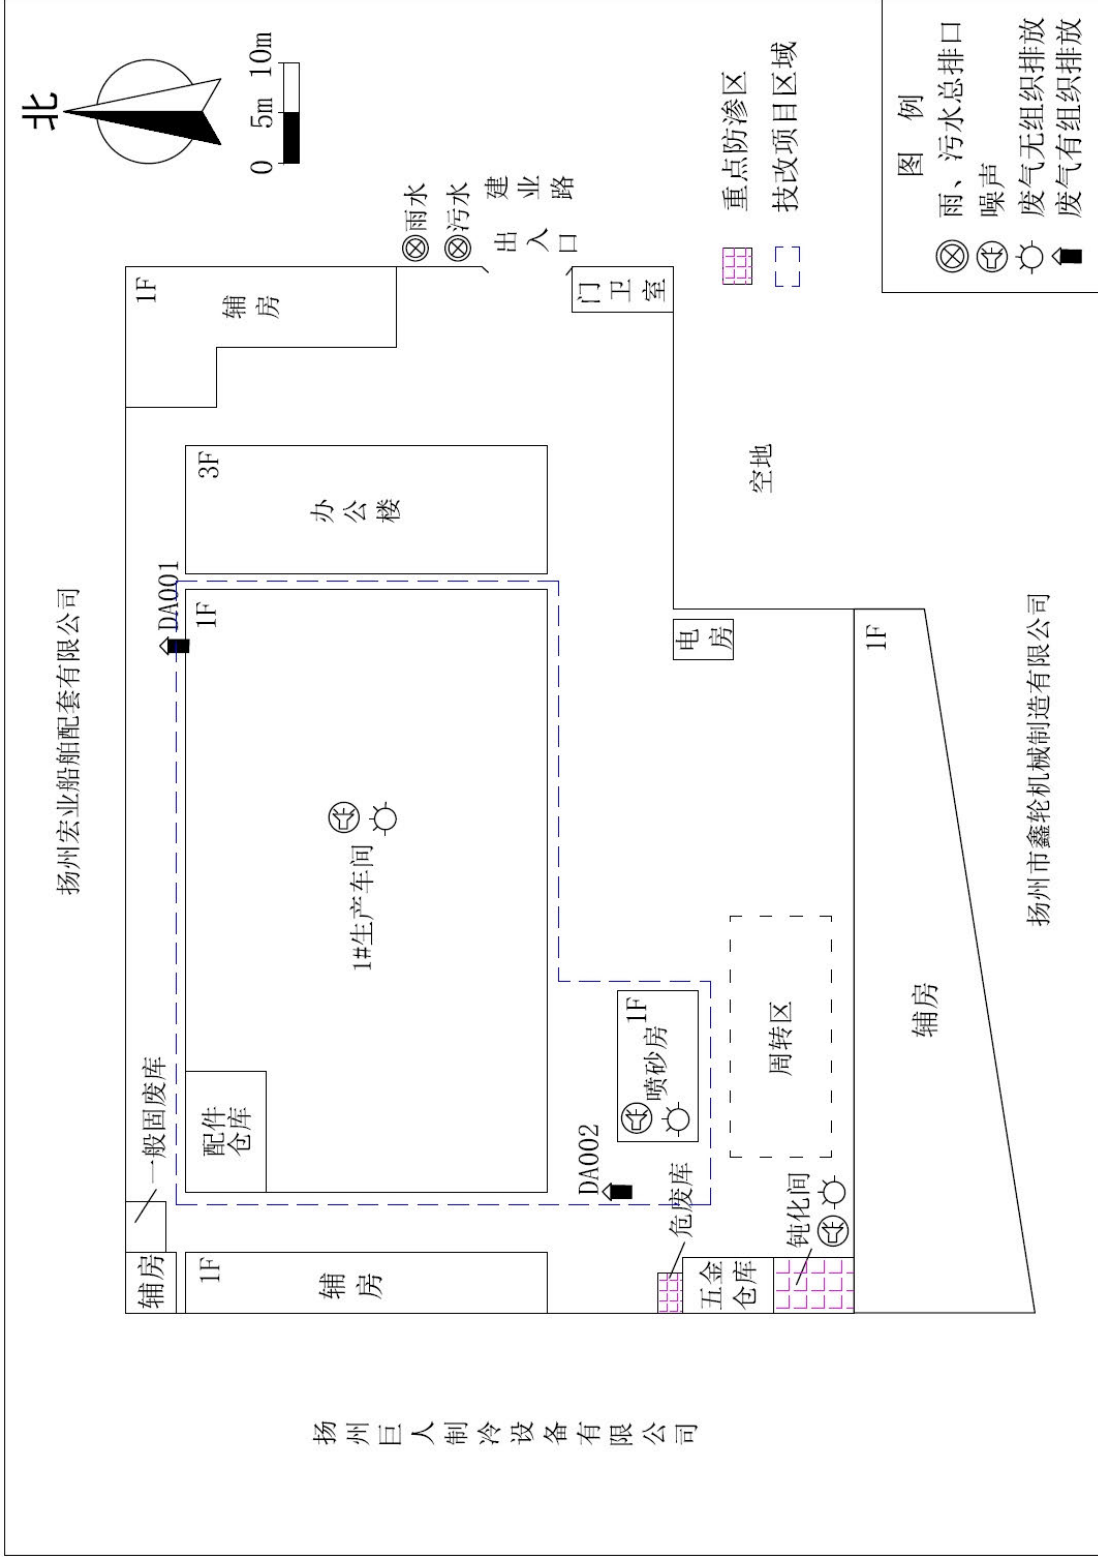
厂区总平面布置图（与环评中基本一致）
